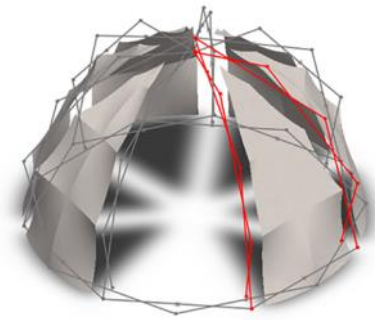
Esquema domo desplegable con cubierta seccionada.
